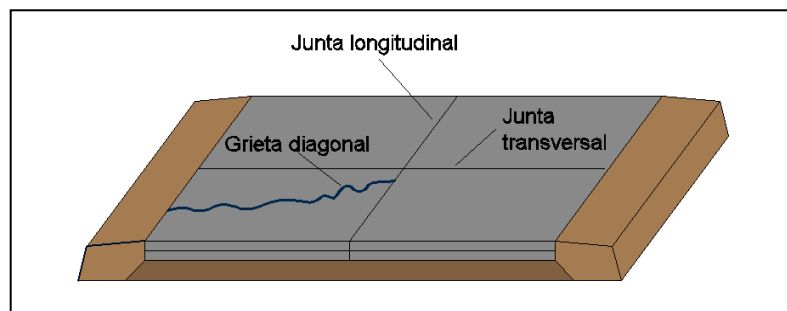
Esquema de grietas diagonales en la calzada
